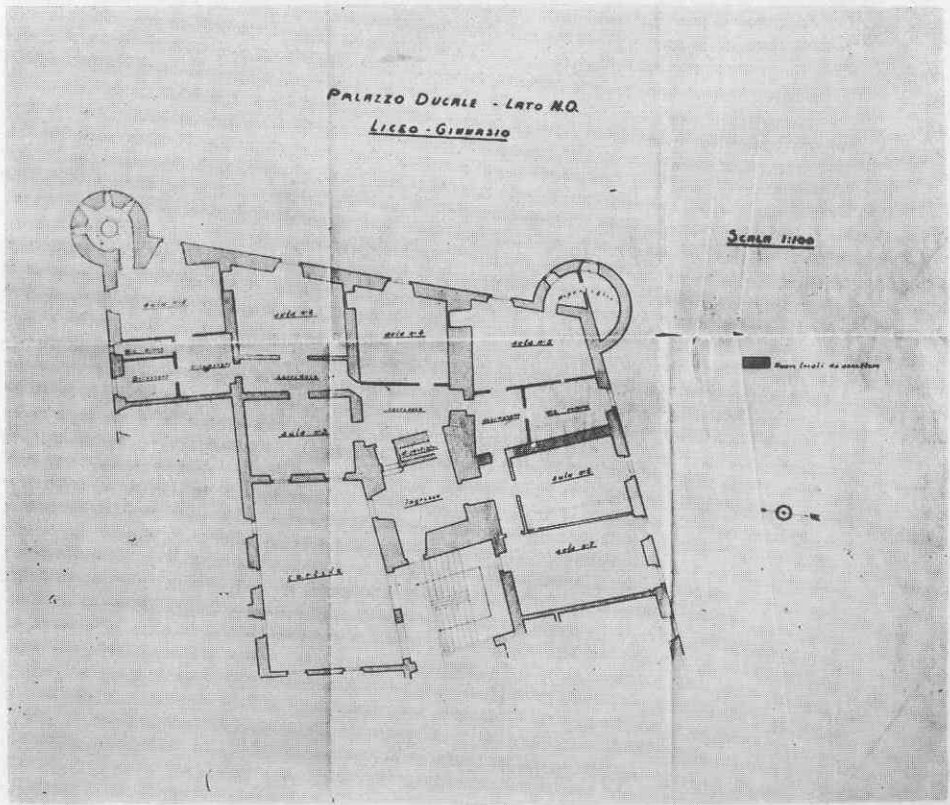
Pianta dei locali adibiti a Liceo-Ginnasio.
